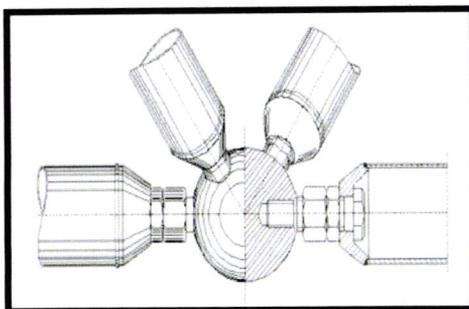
= les poutres tridimensionnelles et la rotule de fixation
